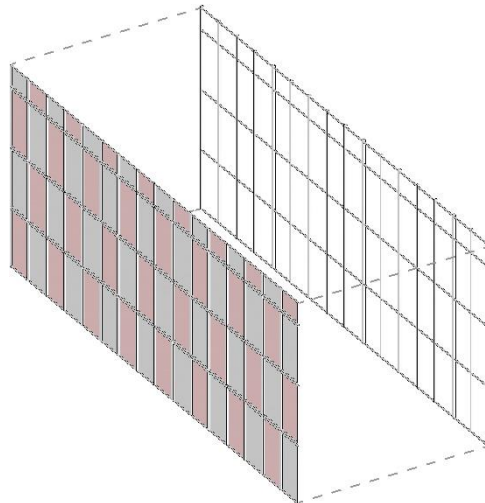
Parrilla y Paneles Metálicos. Fuente: Elaboración Propia
